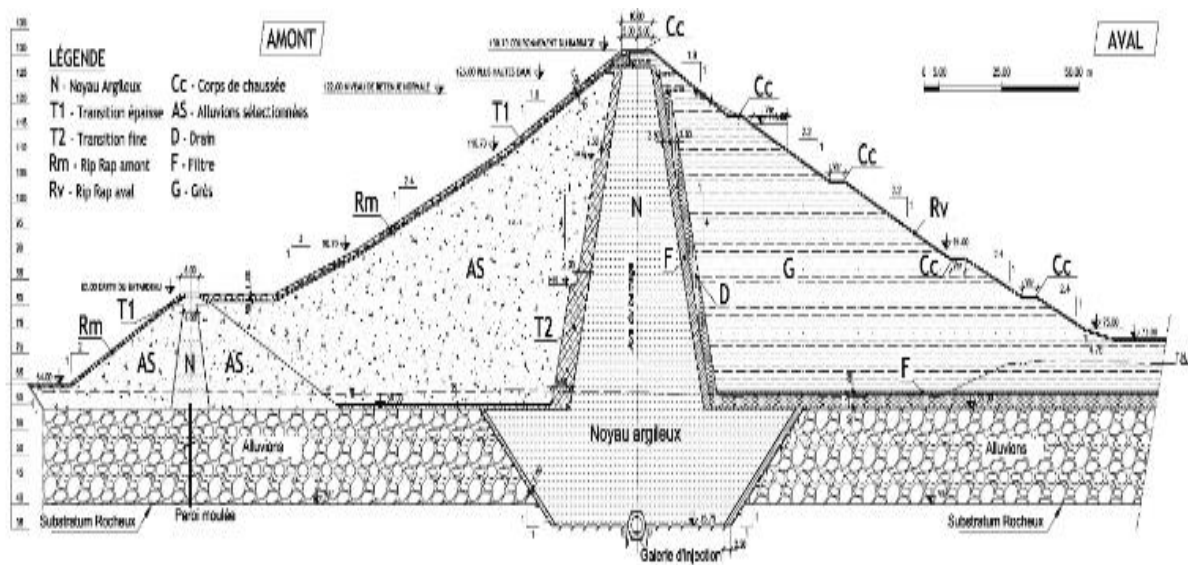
Coupe transversale du corps du barrage Souk N'TLETA (ANBT)
